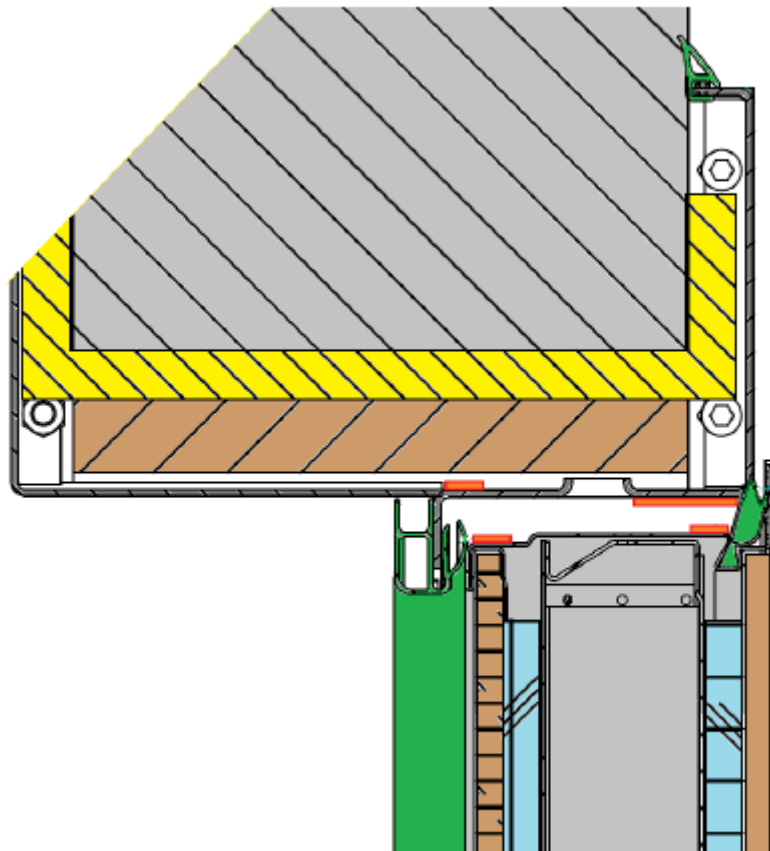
detail schuimvormers t.p.v. de bovenregel
